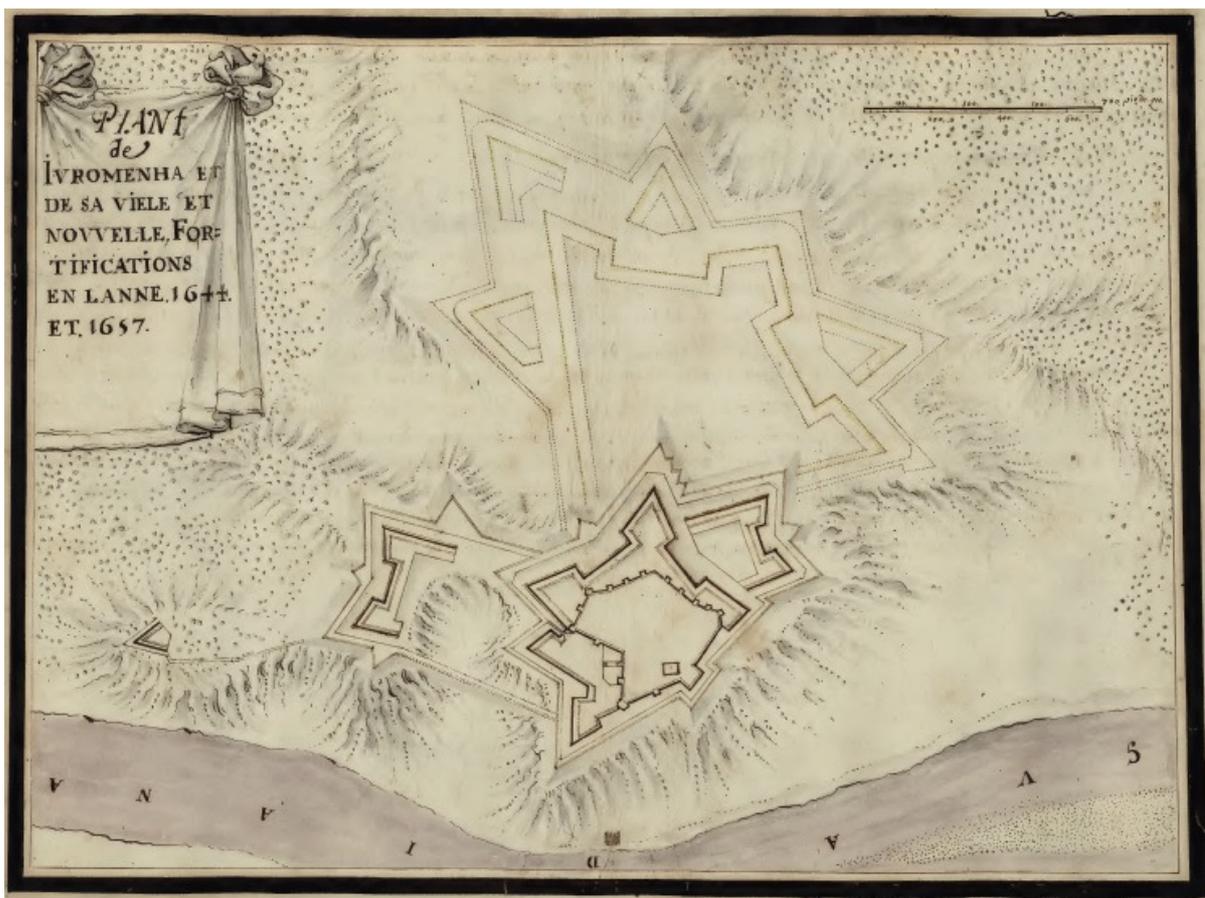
Planta da Praça de Juromenha executada por Nicolau de Langres, em 1657
